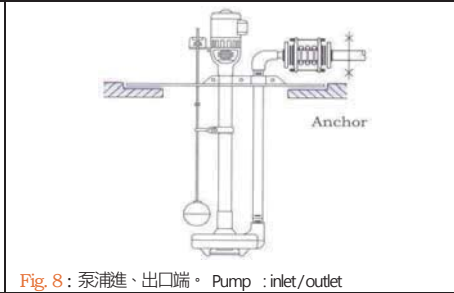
泵浦進、出口端。 Pump : inlet/outlet
